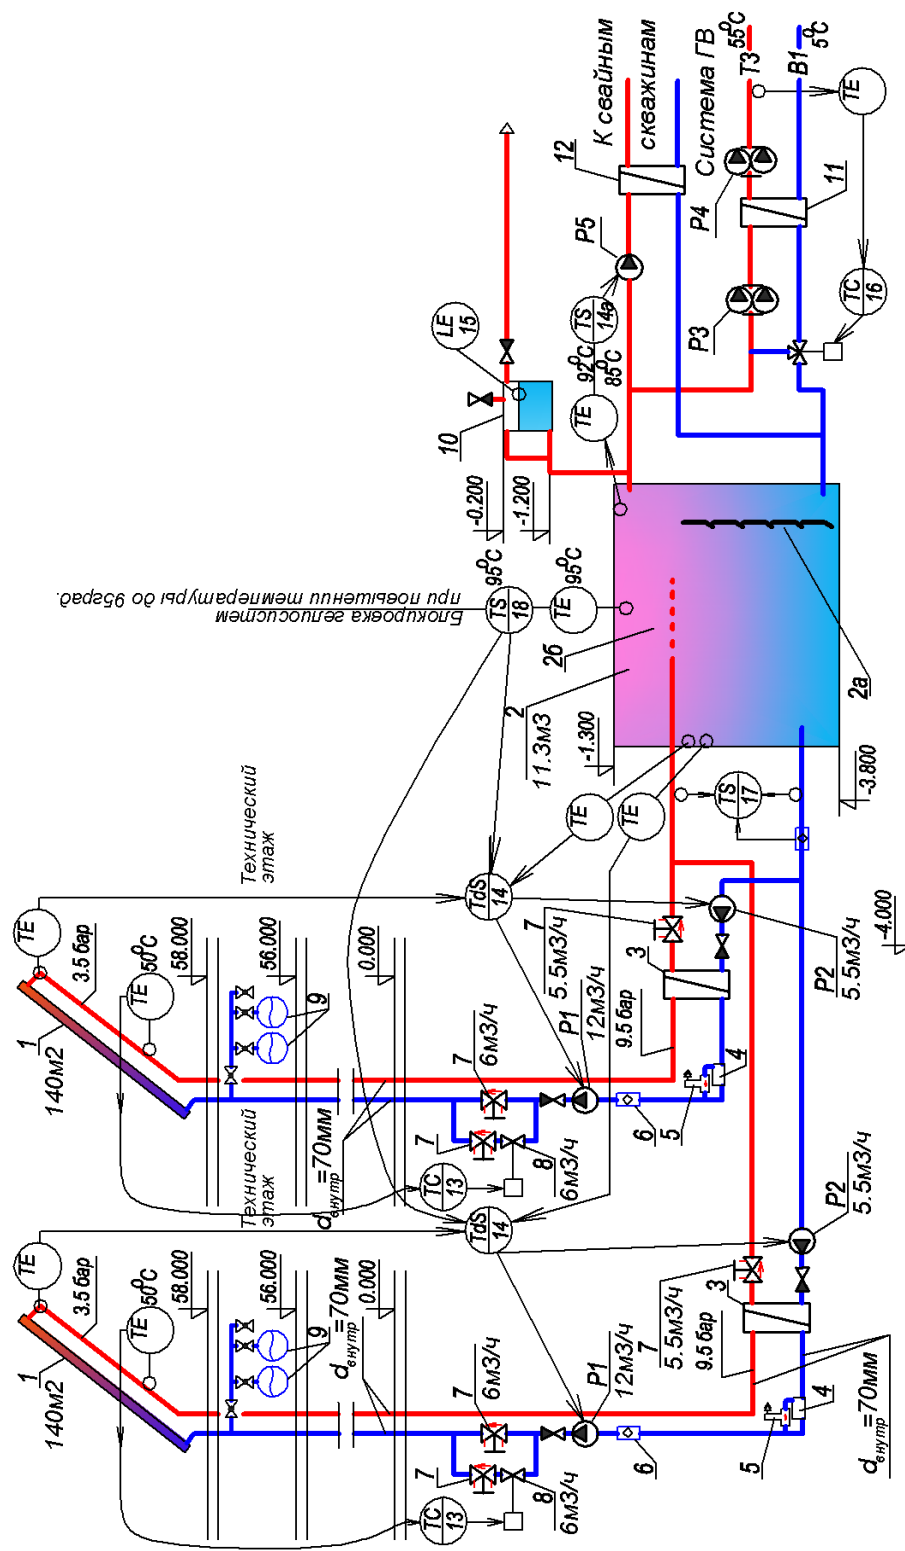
Схема геосистемы 160-х квартир 20-ти этажного жилого дома
